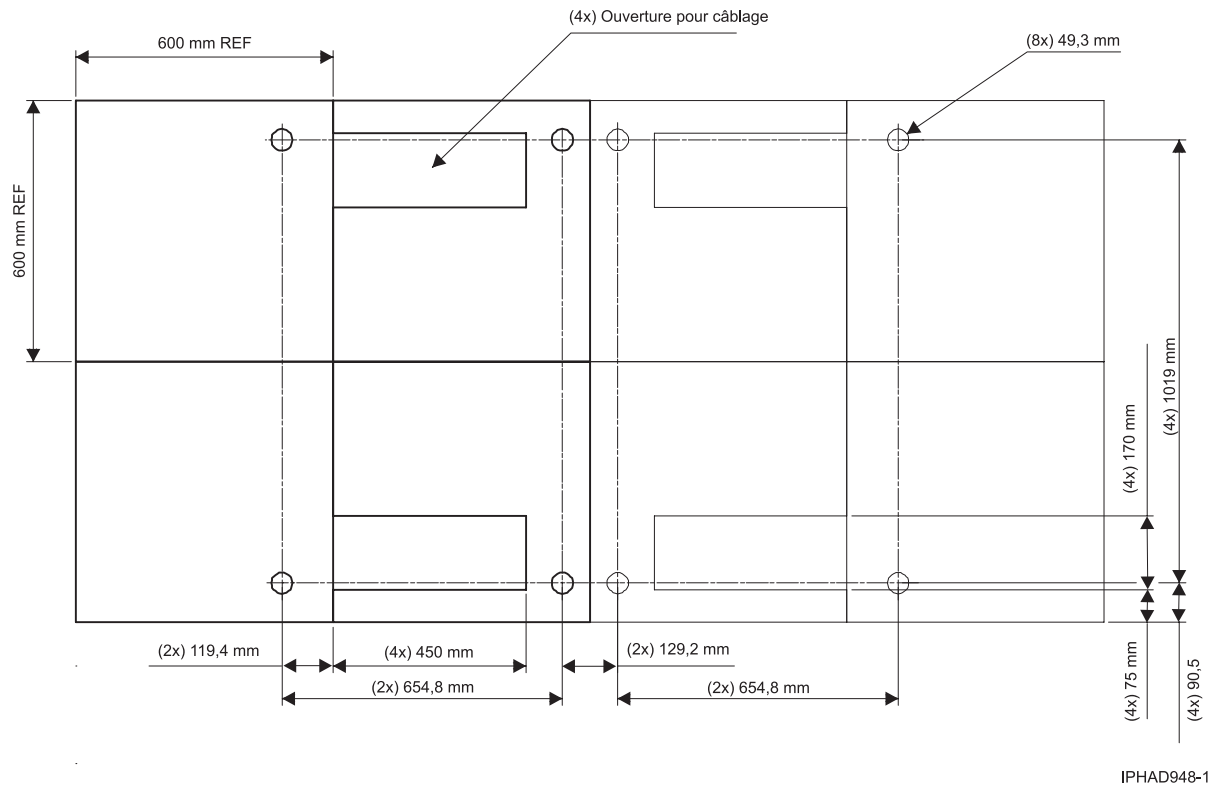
Positionnement des boulons à oeil pour dalles de plancher de 600 mm
